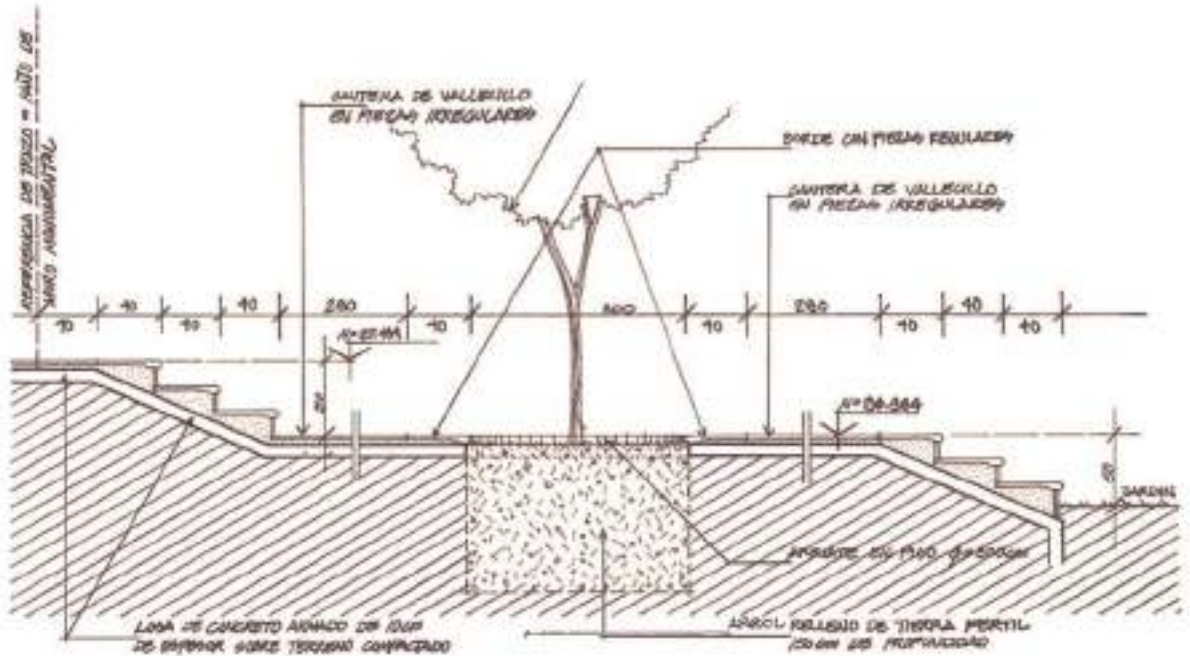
Detalle de escalera en plaza, corporativo DeAcero, Monterrey, Nuevo León
